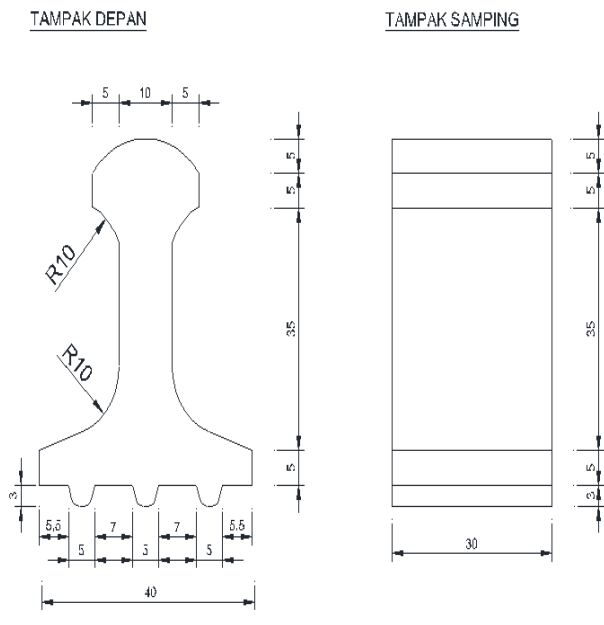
Modul Dinding atau Lantai Tipe-T Beton Pracetak Modular
